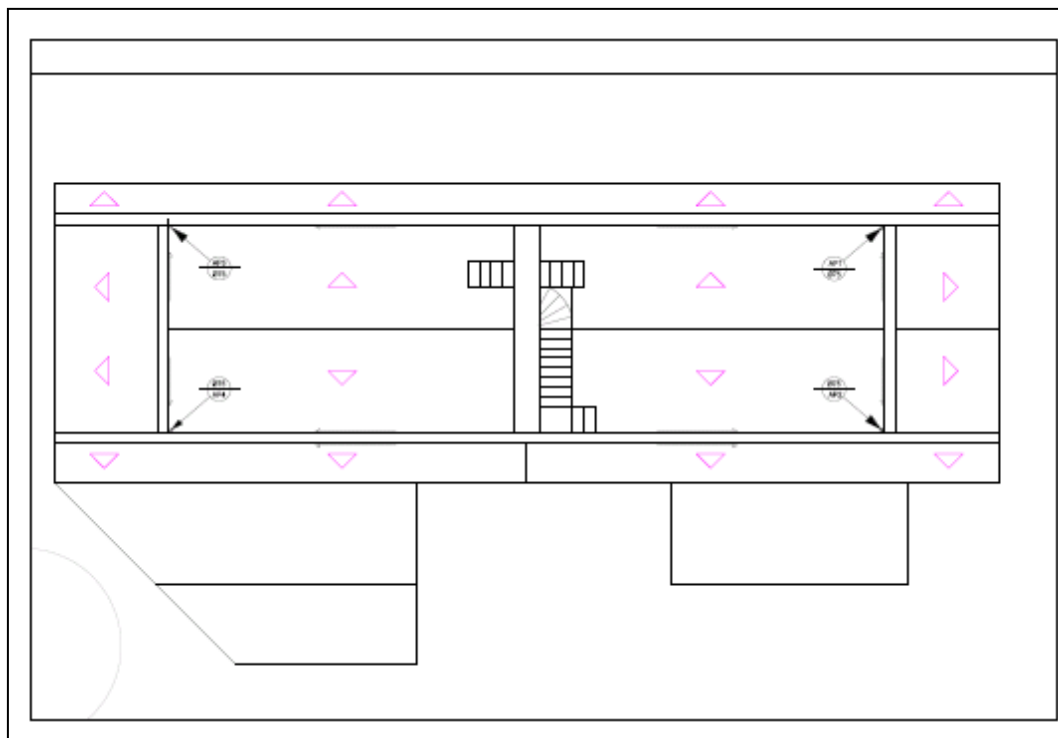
Configuração final da cobertura, com caimento de águas diretamente para fora. Fonte: AUTOR (2017).
